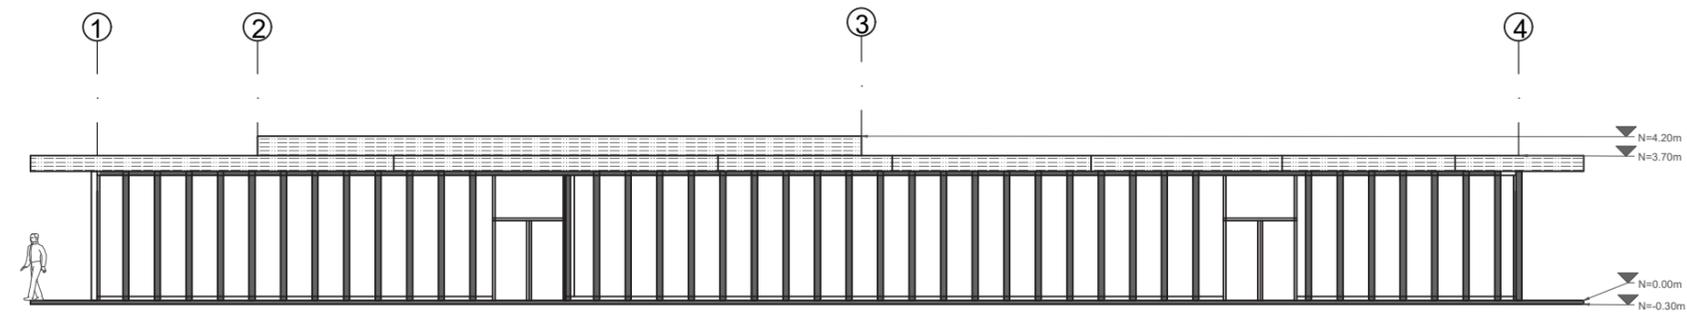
PLANIMETRÍA\_ELEVACIÓN FRONTAL
